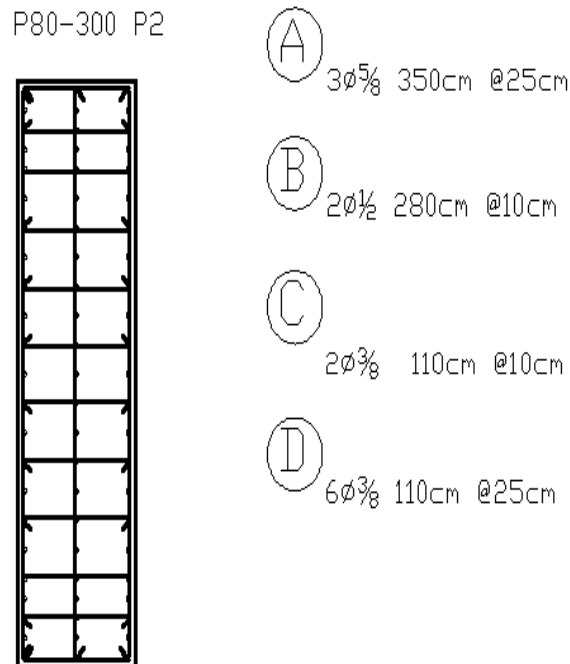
Sección transversal de muro dirección Y nivel 2.
